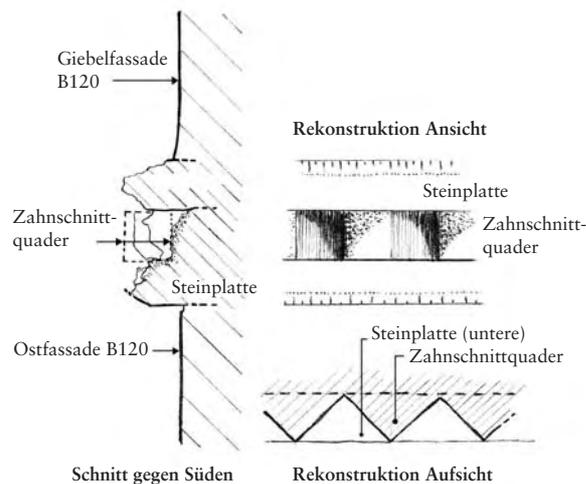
Müstair, Kloster St. Johann. Kirche, Ostfassade unter dem Apsidendach. Ansicht und Schnitte durch das gemauerte Horizontalgesims und Rekonstruktion. Mst. 1:5.
